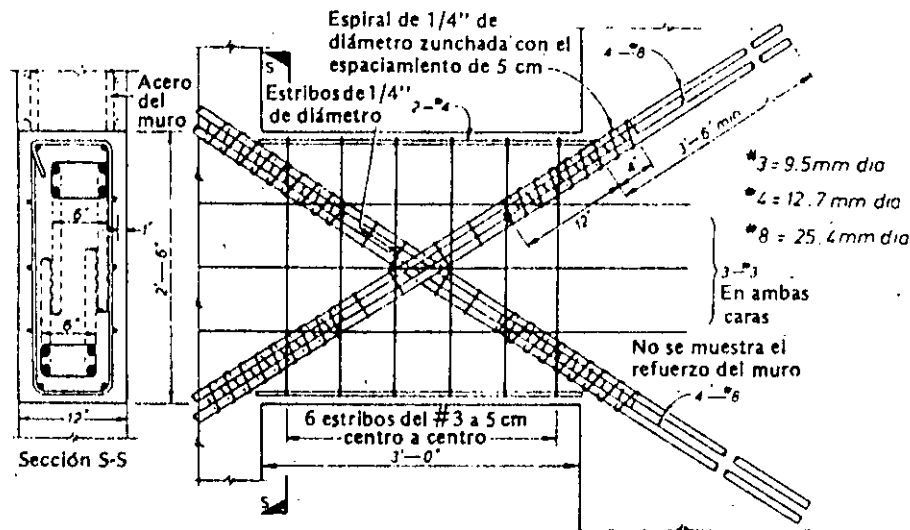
Sugerencia para la disposición del acero en una viga de acoplamiento con refuerzo en diagonal.
